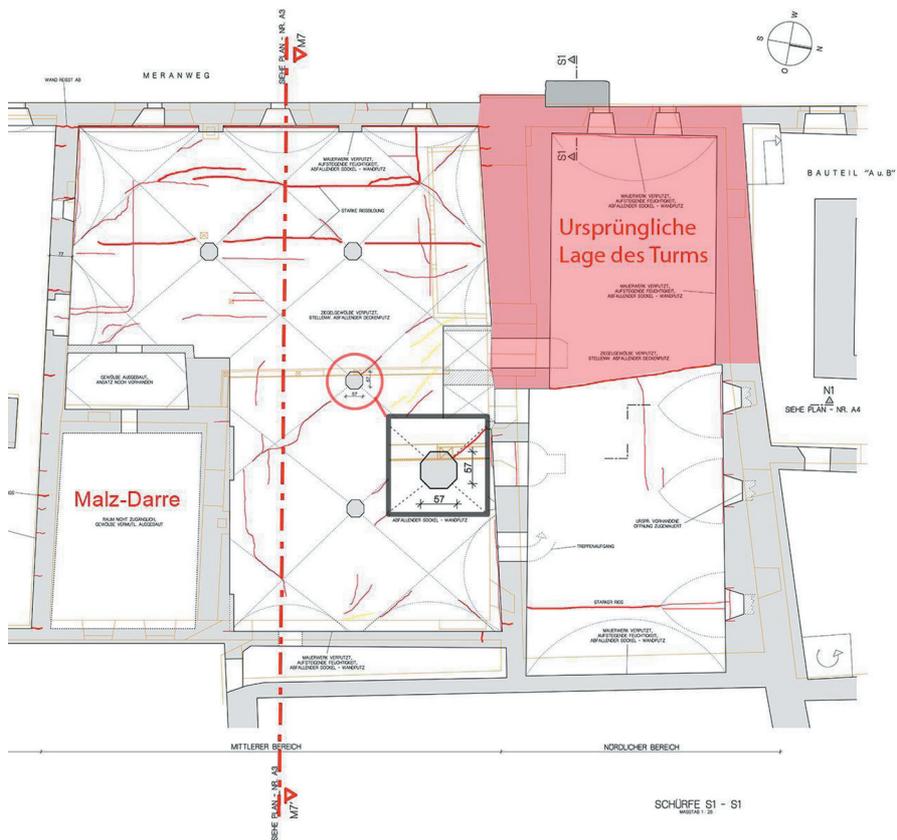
Grundrissauszug der Höchstetterbrauerei/ehemals „Chamer Stadtschloss“ mit den sich im KG befindenden Gewölbekonstruktionen aus dem Plangutachten der Firma ALS von 2009
